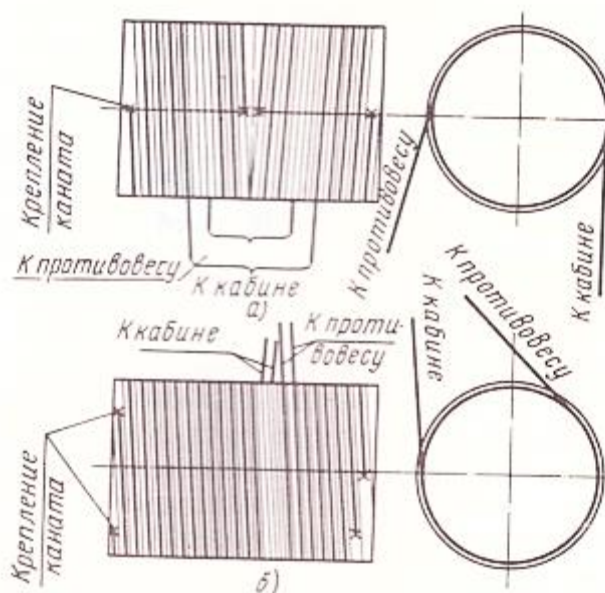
Схемы укладки канатов на барабане при установке лебедки
